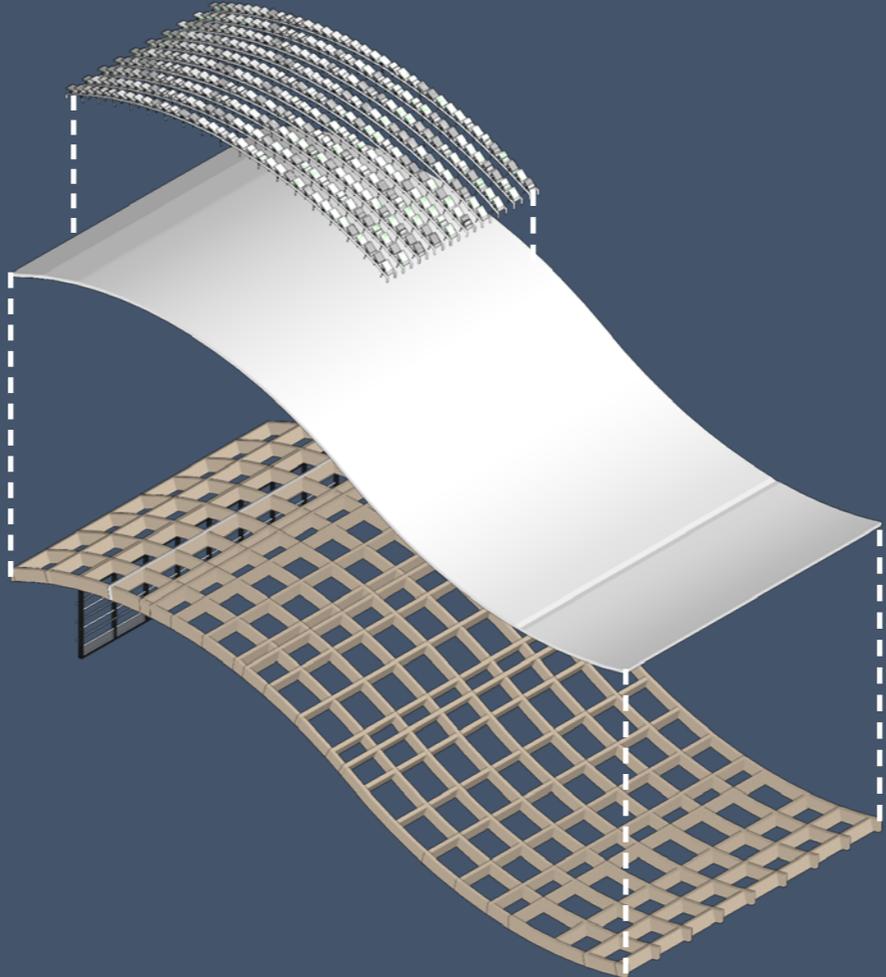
Planta da cobertura. Fonte: Autoria própria
